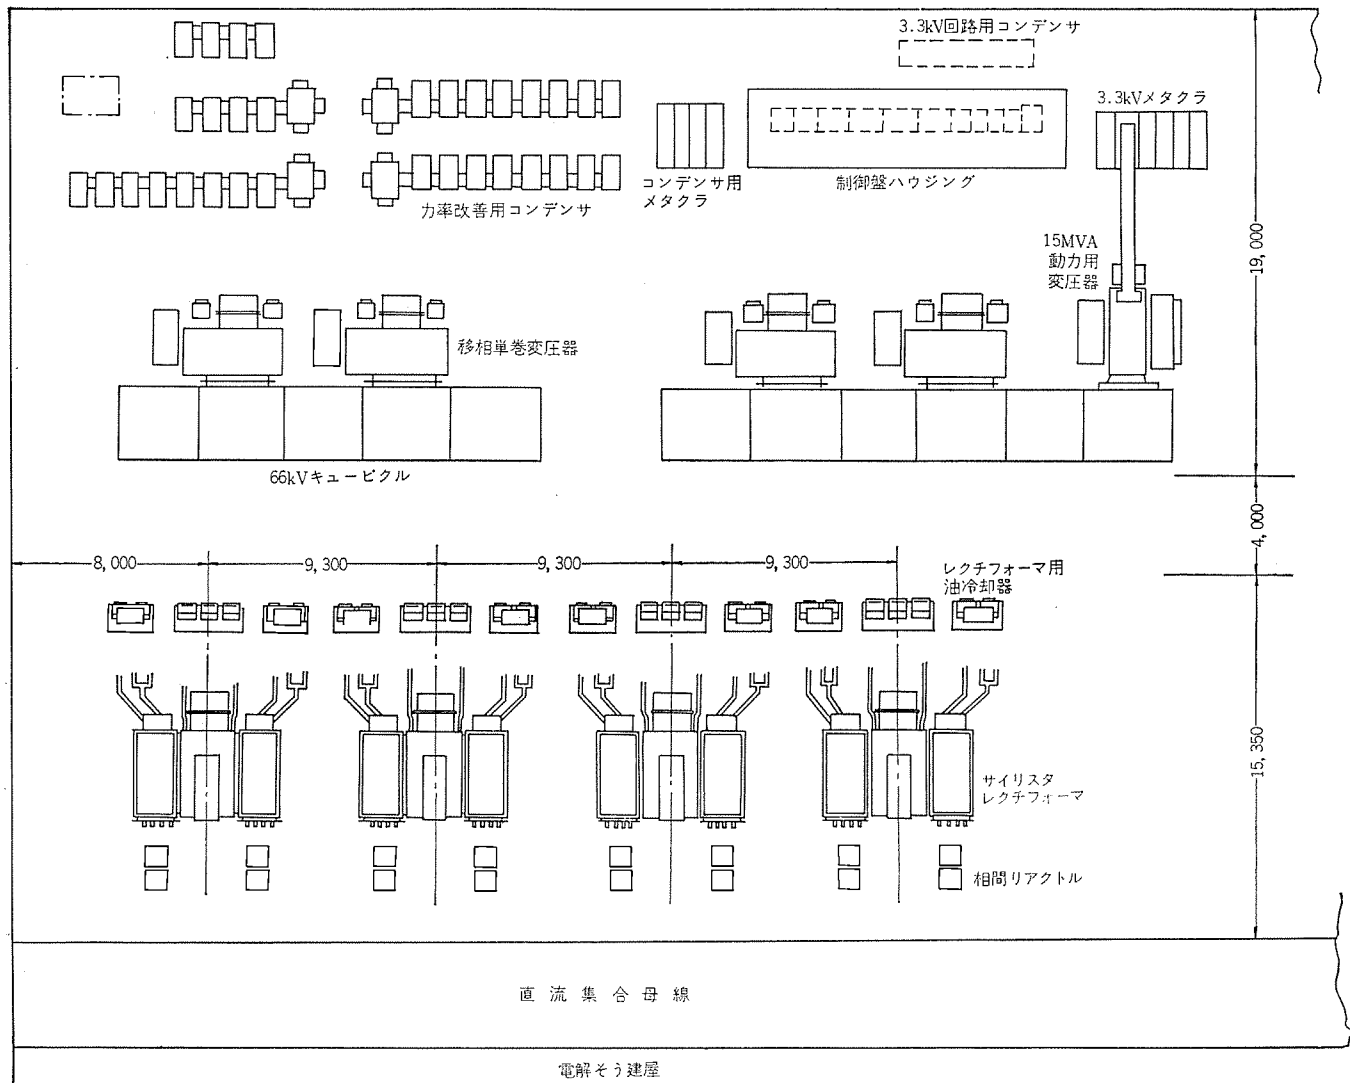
整流装置配置図 Arrangement of rectifier equipment.
